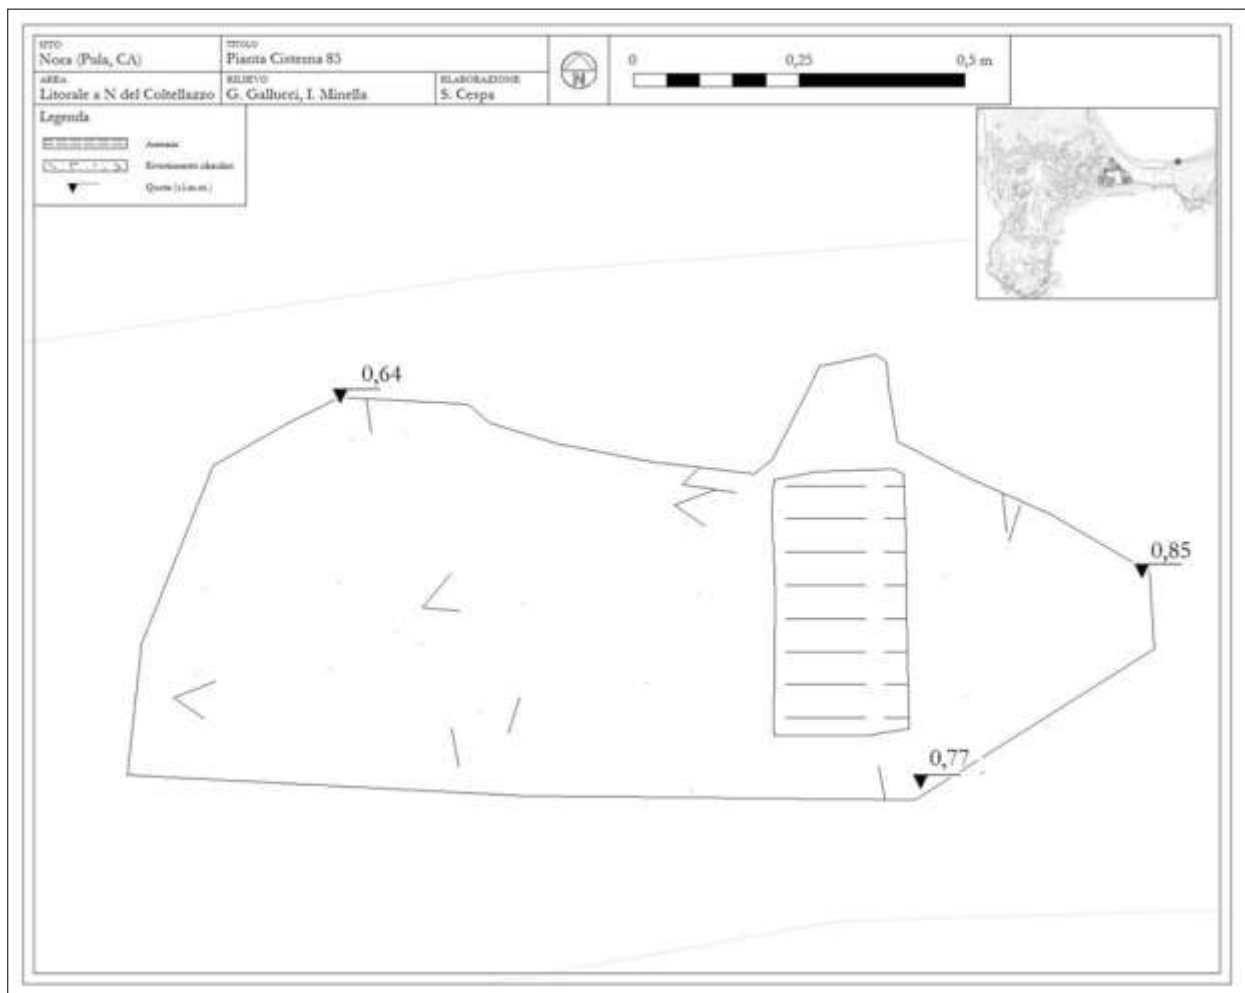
Pianta della presunta cisterna 85 (elaborazione dell'autore).
